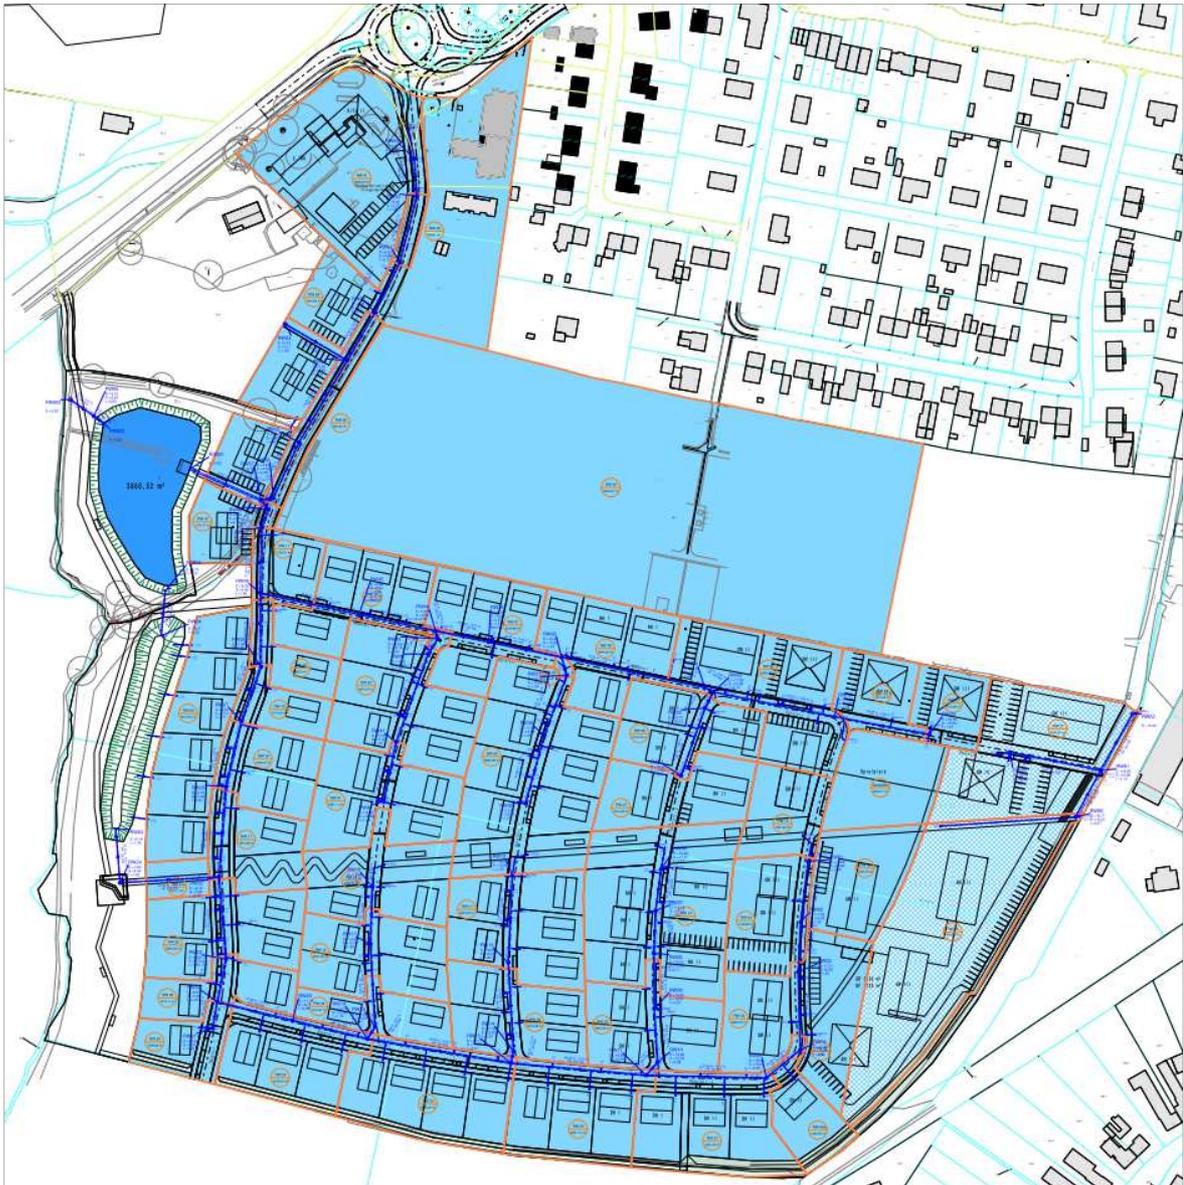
Aus Lageplan ‚Hydraulik‘ mit Kennzeichnung der angeschl. Flächen von: IB HAUCK 28.09.2018
